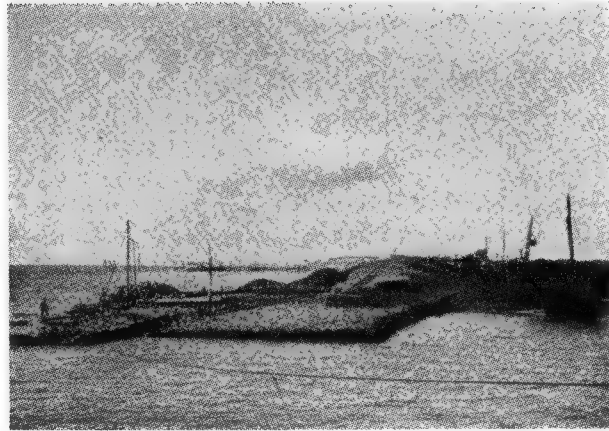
Colocación de enramadas con piedras para afianzar el fondo del mar.
